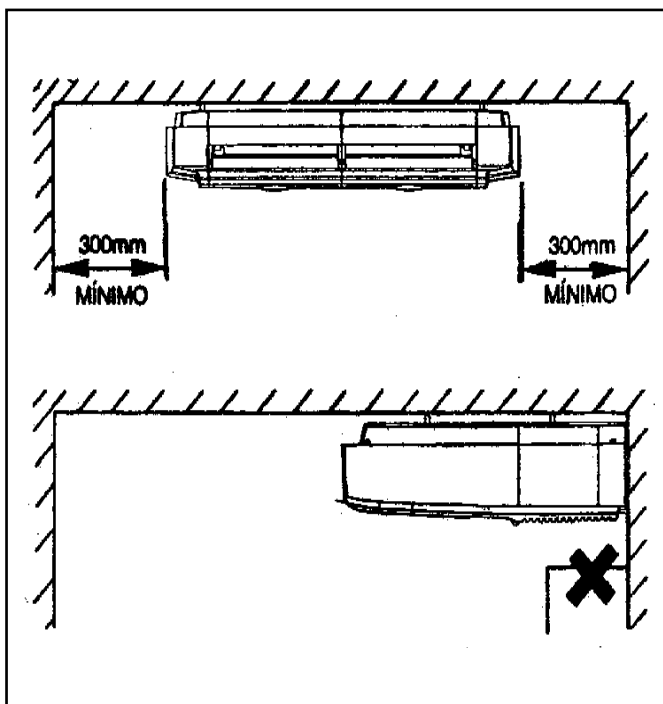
MONTAGEM TETO - UNDER CEILING
